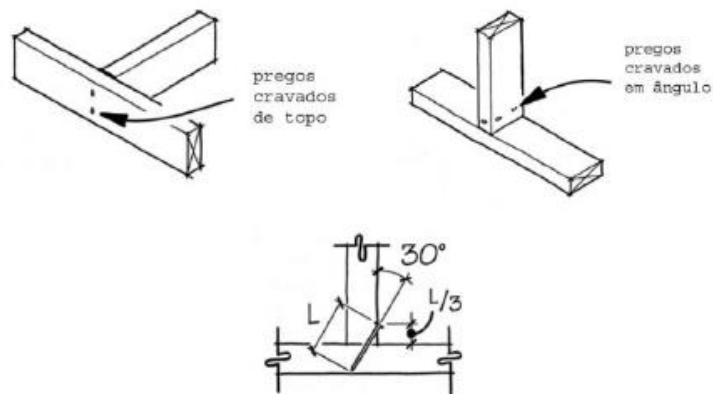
Estrutura: Encontro de painéis – Light Wood Frame
